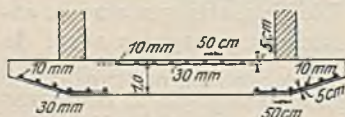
Gründung auf durchgehender Eisenbetonplatte mit gleichbleibendem Querschnitt.
